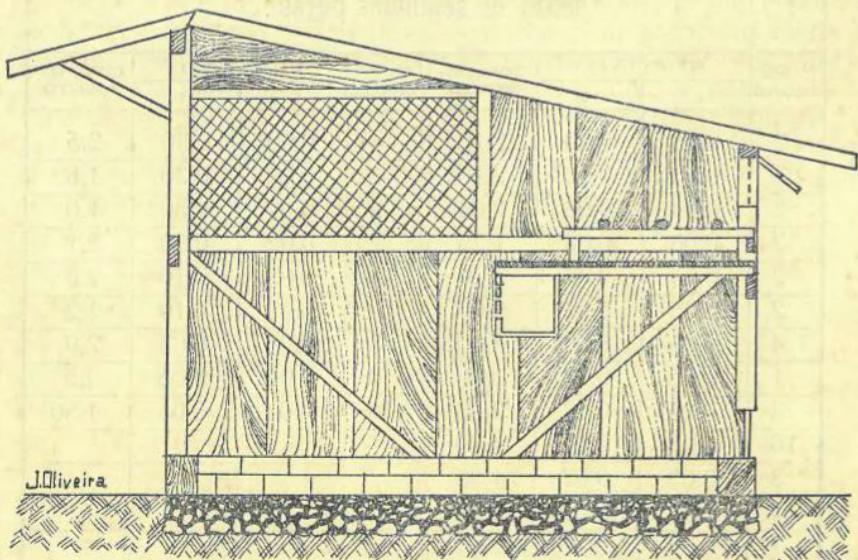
Planta do galinheiro nº. 1, tendo no verso o material que se fará necessário para a sua construção de madeira ou de alvenaria de tijolos.
